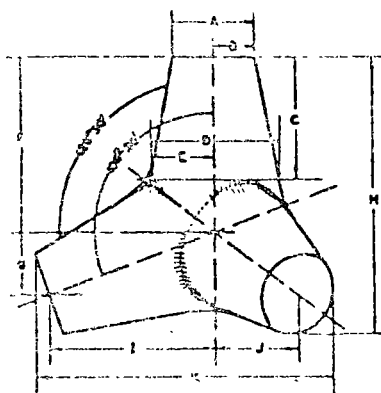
ELEMENTOS DE CONCRETO PREFABRICADOS
